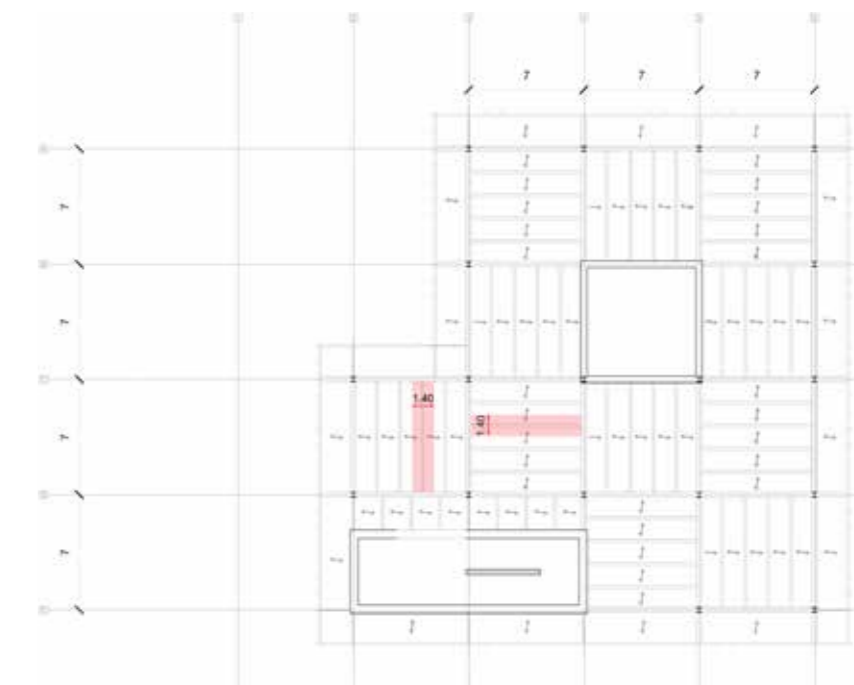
Schema strutturale trave secondaria solaio della copertura
